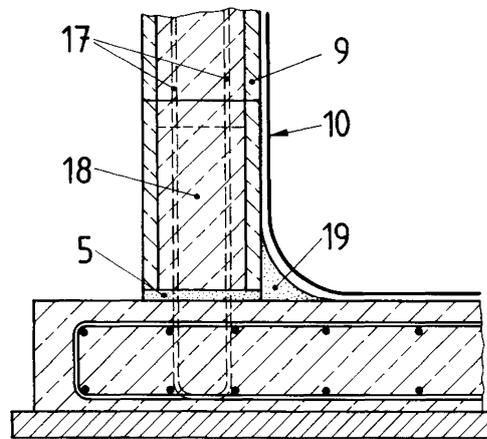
Wand aus Betonschalungssteinen für Güllekanäle
